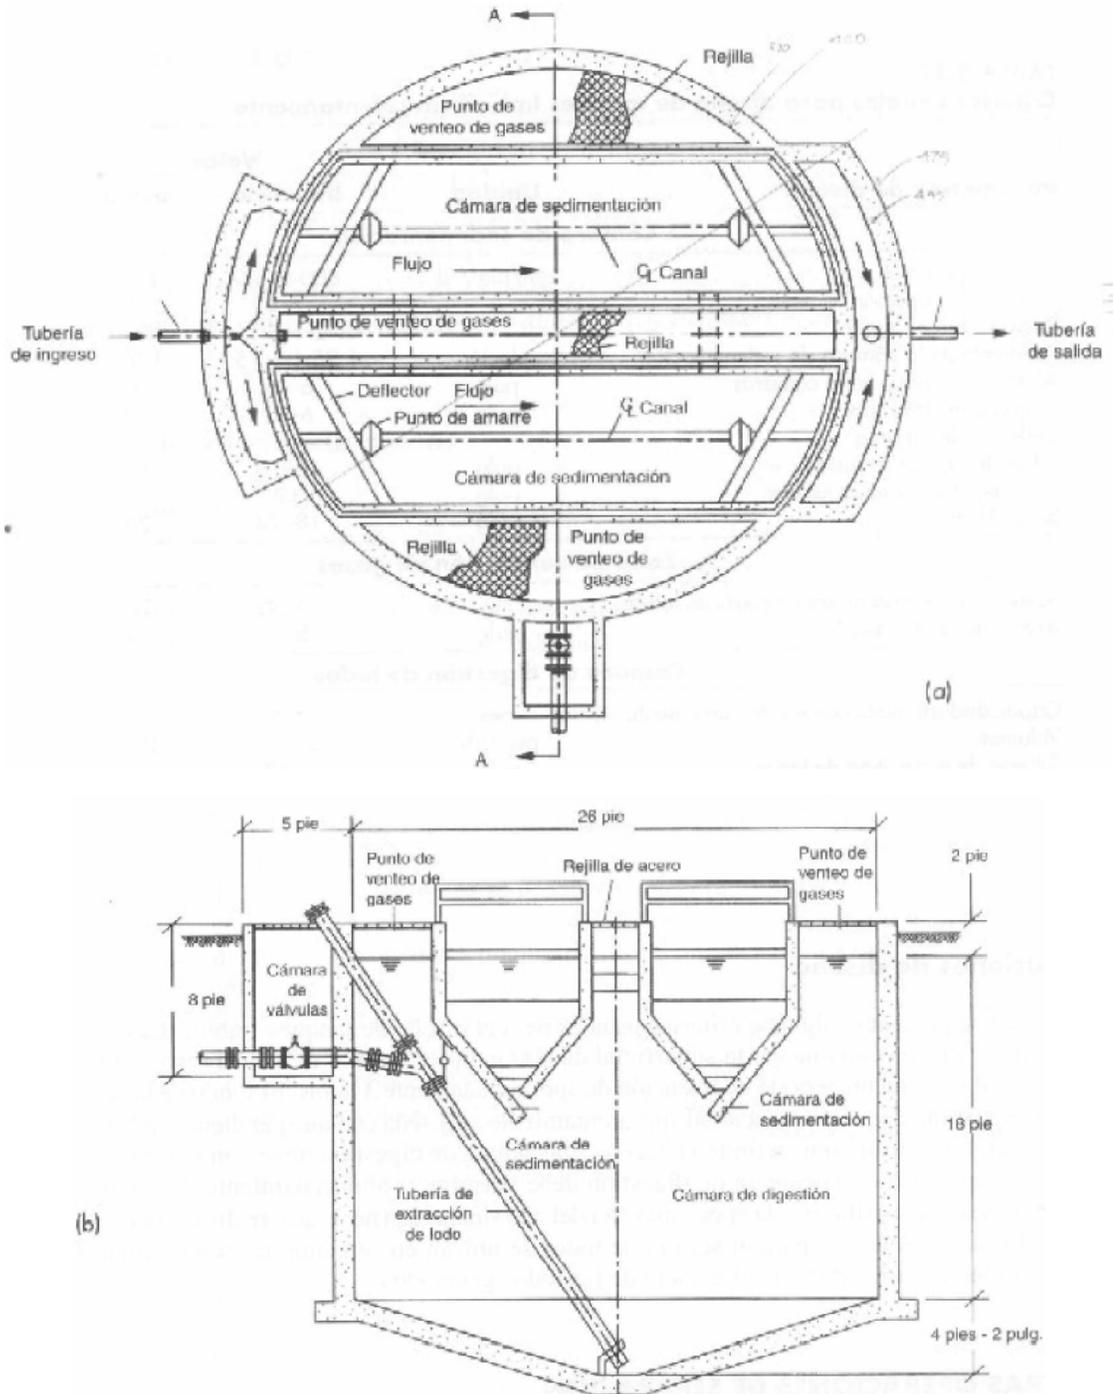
Tanque Imhoff circular: (a) planta y (b) sección transversal.
